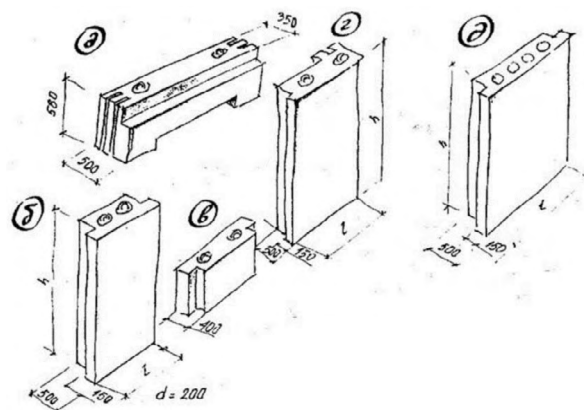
Piezas prefabricadas para fachadas según códigos soviéticos.
